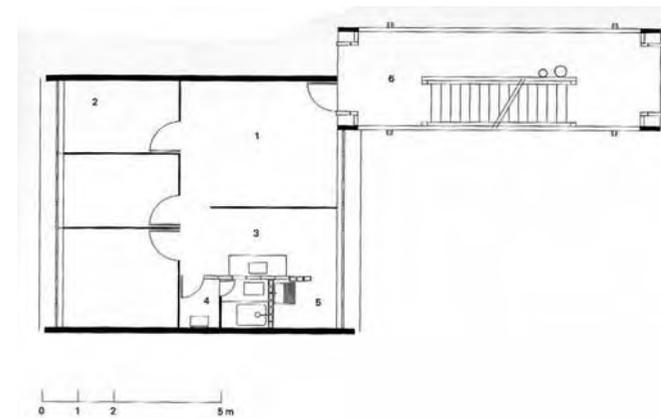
Planta do pavimento padrão do bloco de apartamentos tipo 1, construído através do sistema de túnel deslizante com formas metálicas transferíveis e armários pré-moldados. Imagem retirada do livro Paulo Mendes da Rocha, p. 186.
